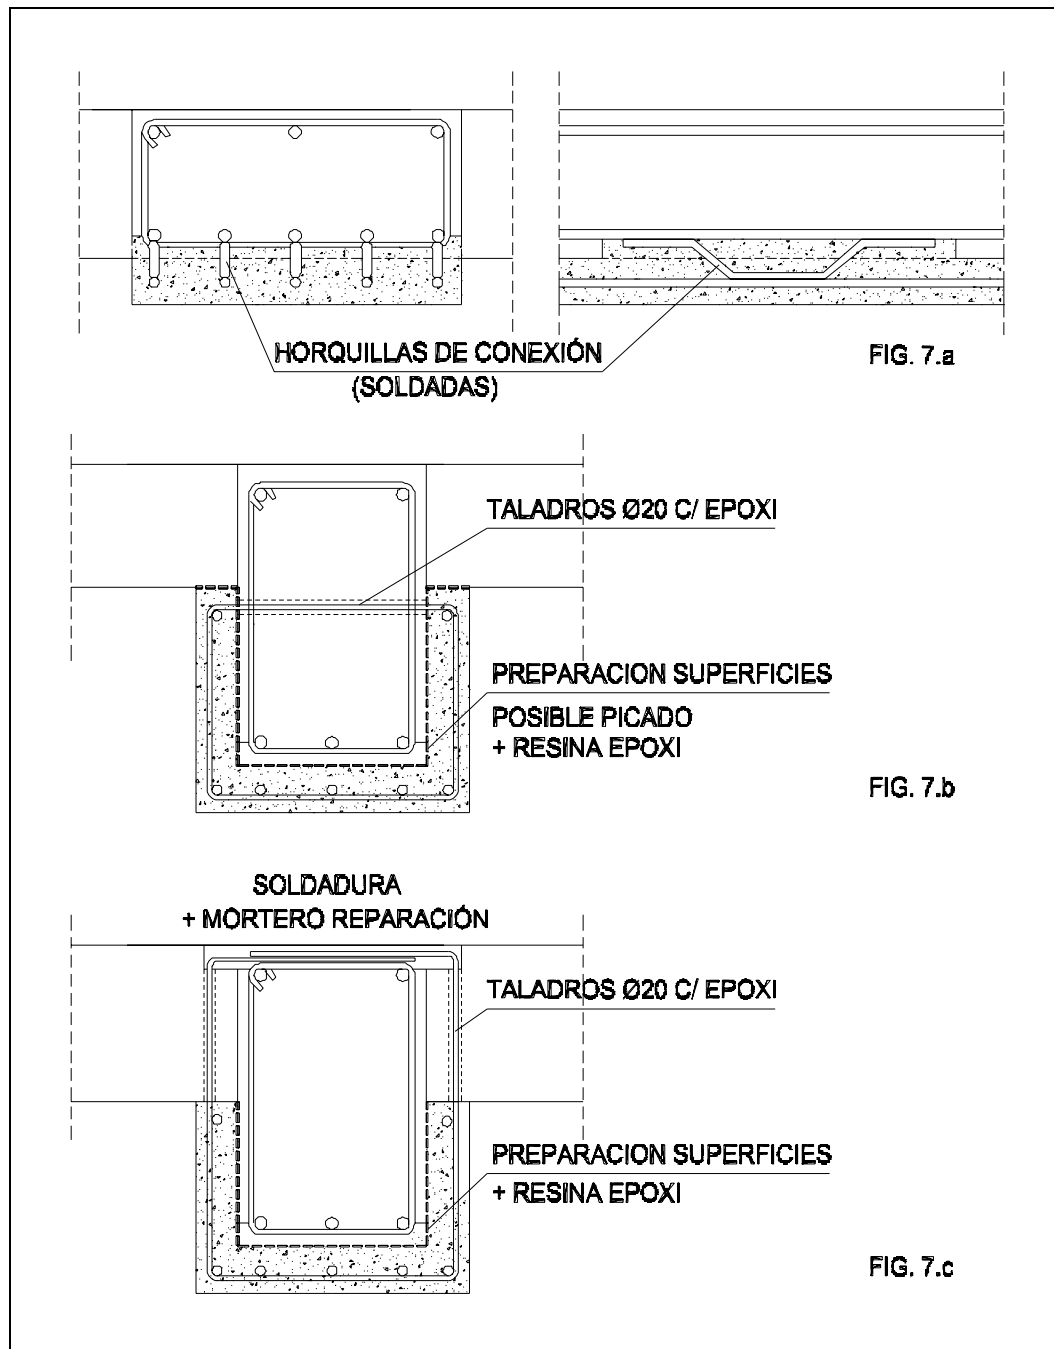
Refuerzo de vigas mediante recrecido con h.a.: unión entre armaduras
